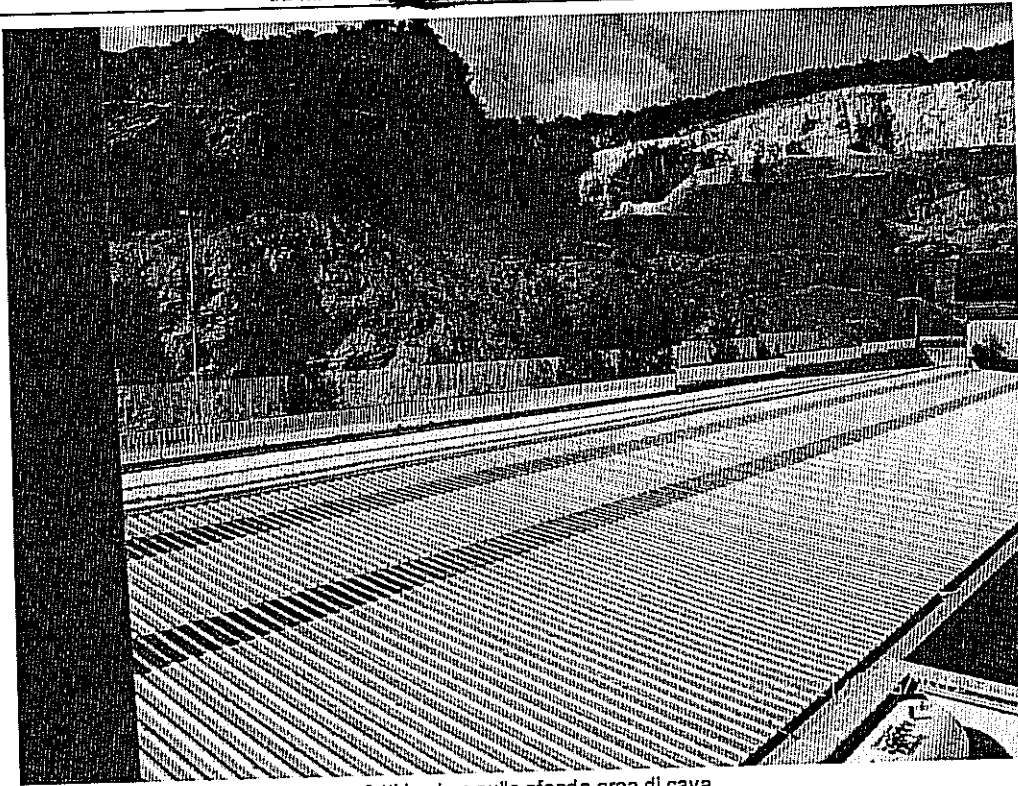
Copertura capannone manufatti in cls e sullo sfondo area di cava
